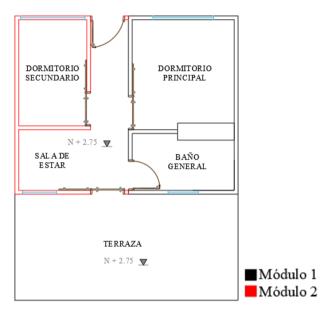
Distribución de áreas de la planta alta de la vivienda mínima modular.
